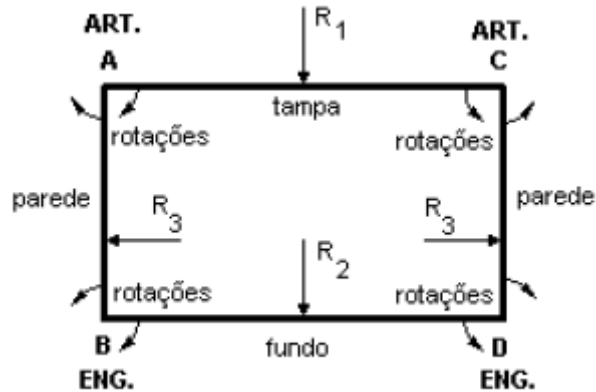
Rotação das bordas das lajes em um reservatório elevado cheio.
